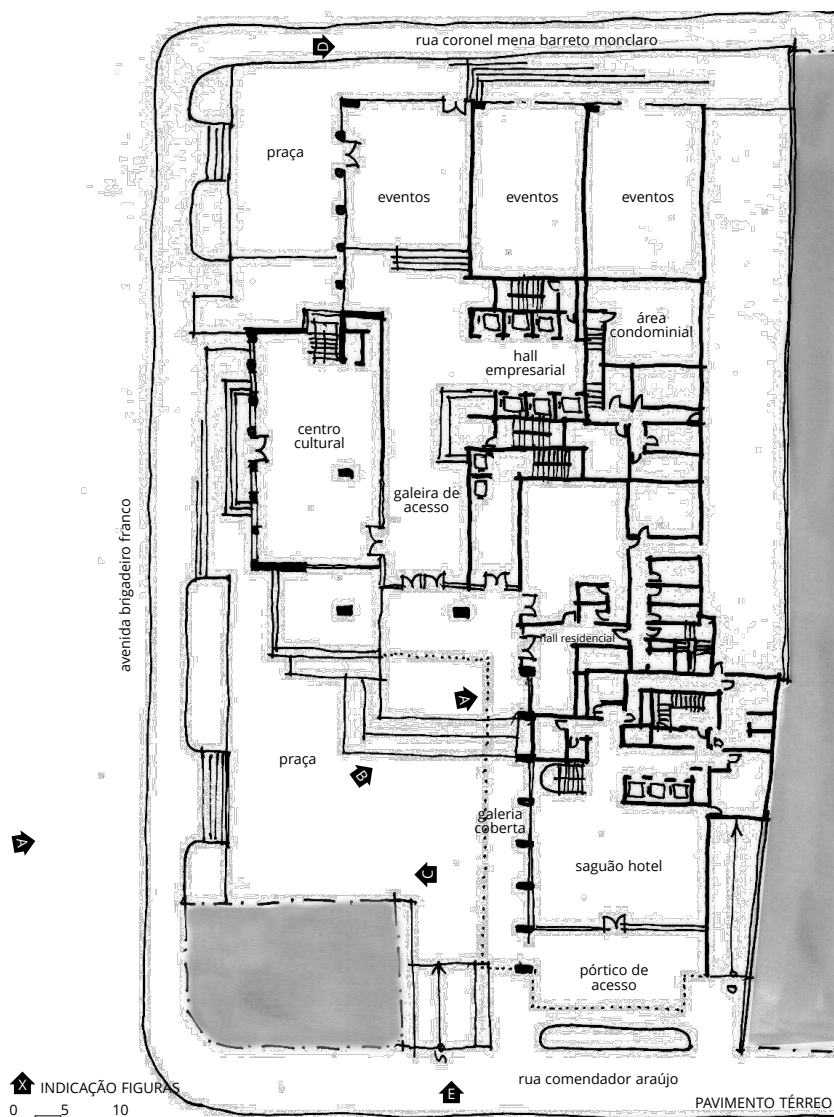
Evolution Towers*. Planta esquemática do pavimento térreo. Croqui elaborado pelo autor, 2015.
